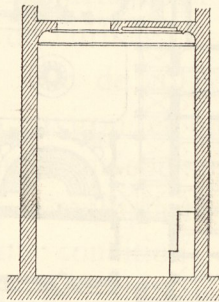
Vitrage en plafond d'une salle haute, n'ayant de vitrines que d'un côté.
